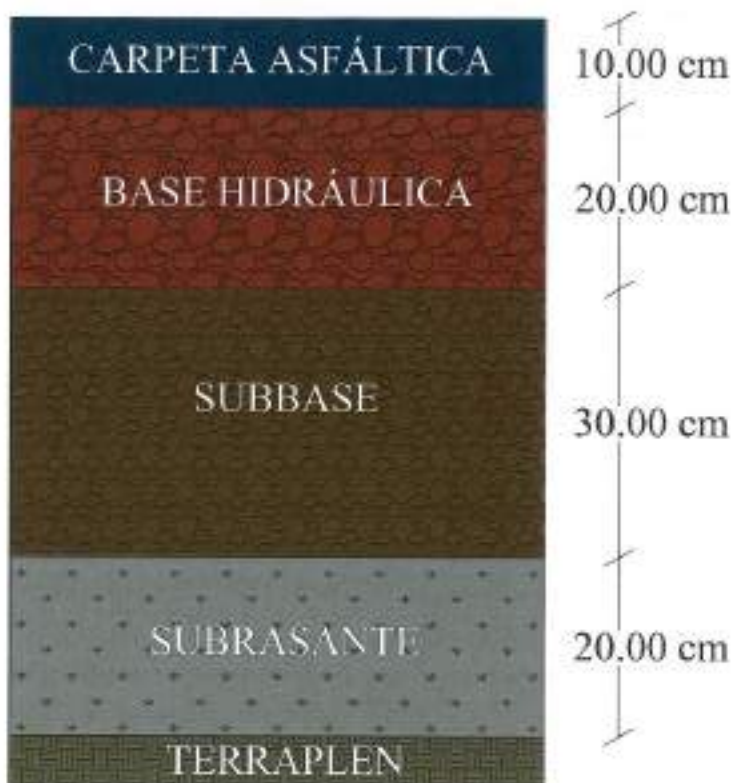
SECCIÓN DE PAVIMENTO PROPUESTA
